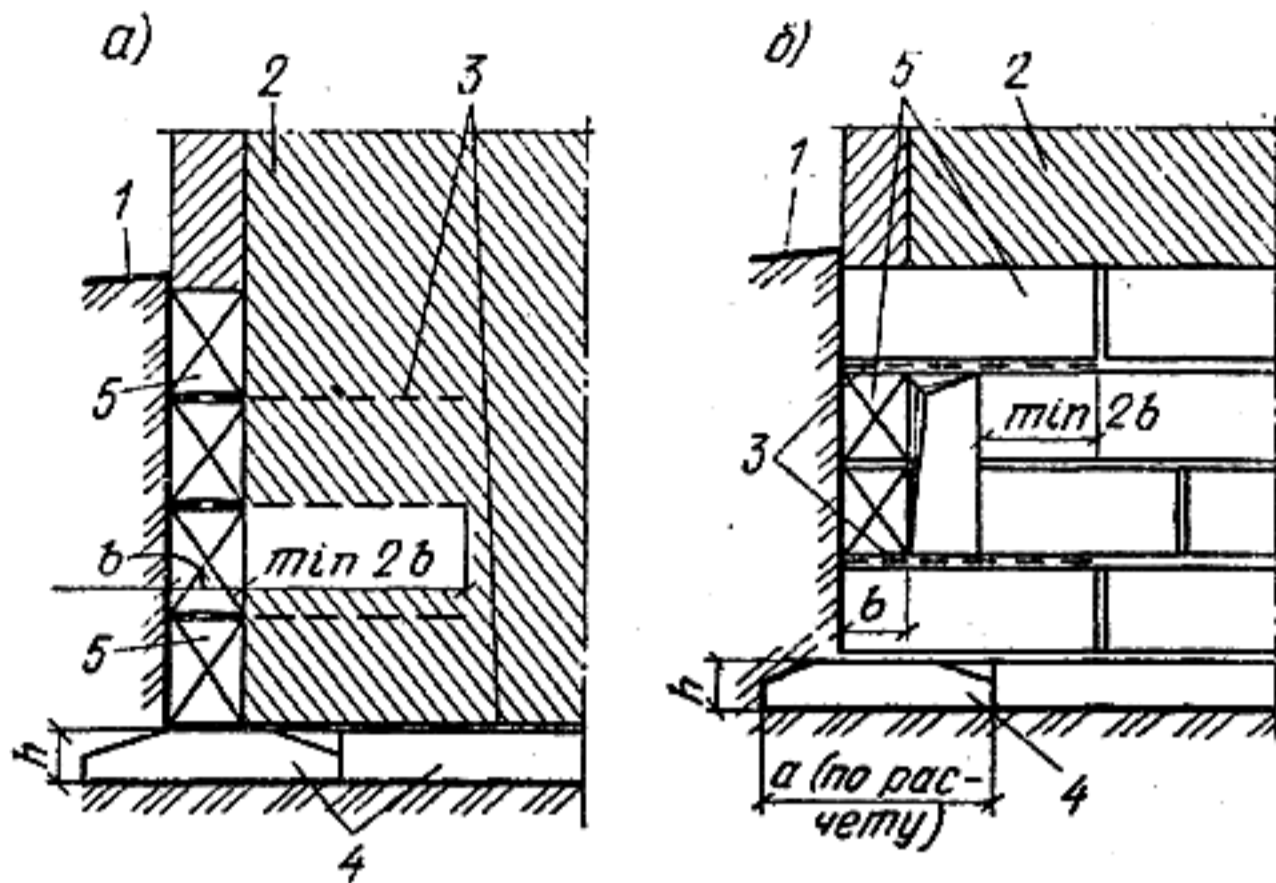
Примыкание кирпичной стены к стене из бетонных блоков (а) и устройство вводов (б)
